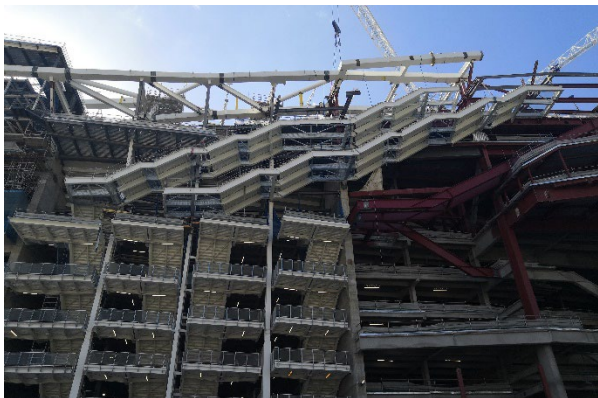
Escaleras perimetrales sur y escaleras voladas (por debajo)
